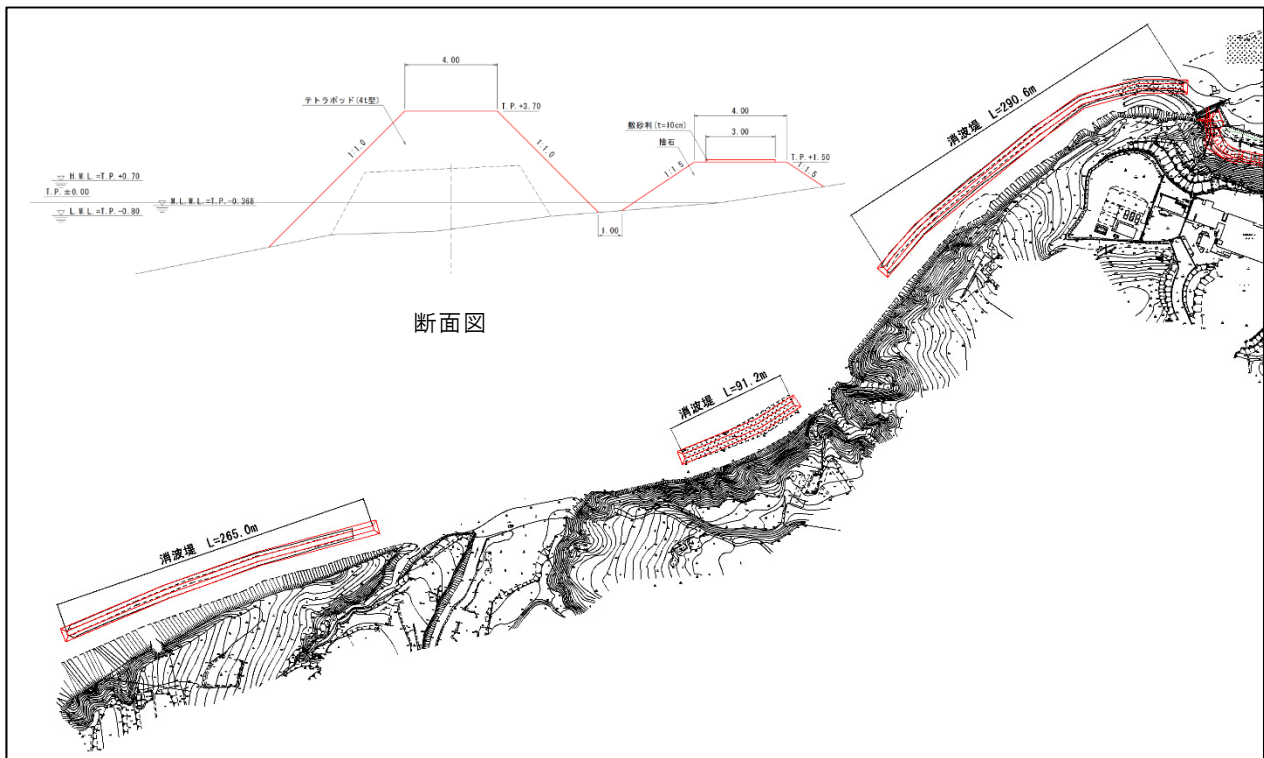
消波堤平面図及び標準断面図【中島海岸】
